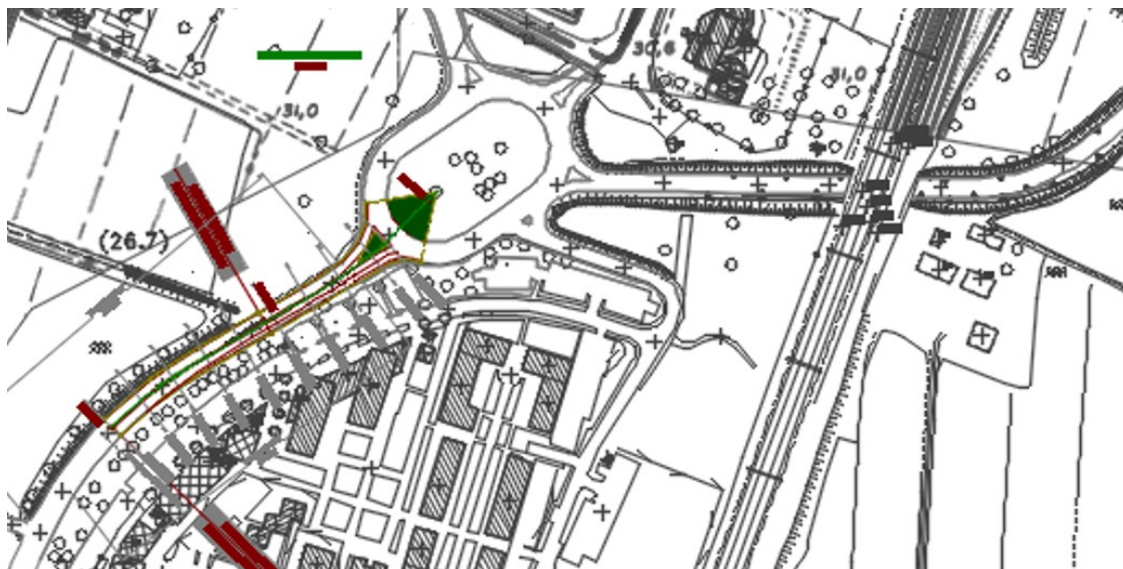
Planimetria adeguamento innesto rotatoria Oro - Pilla
